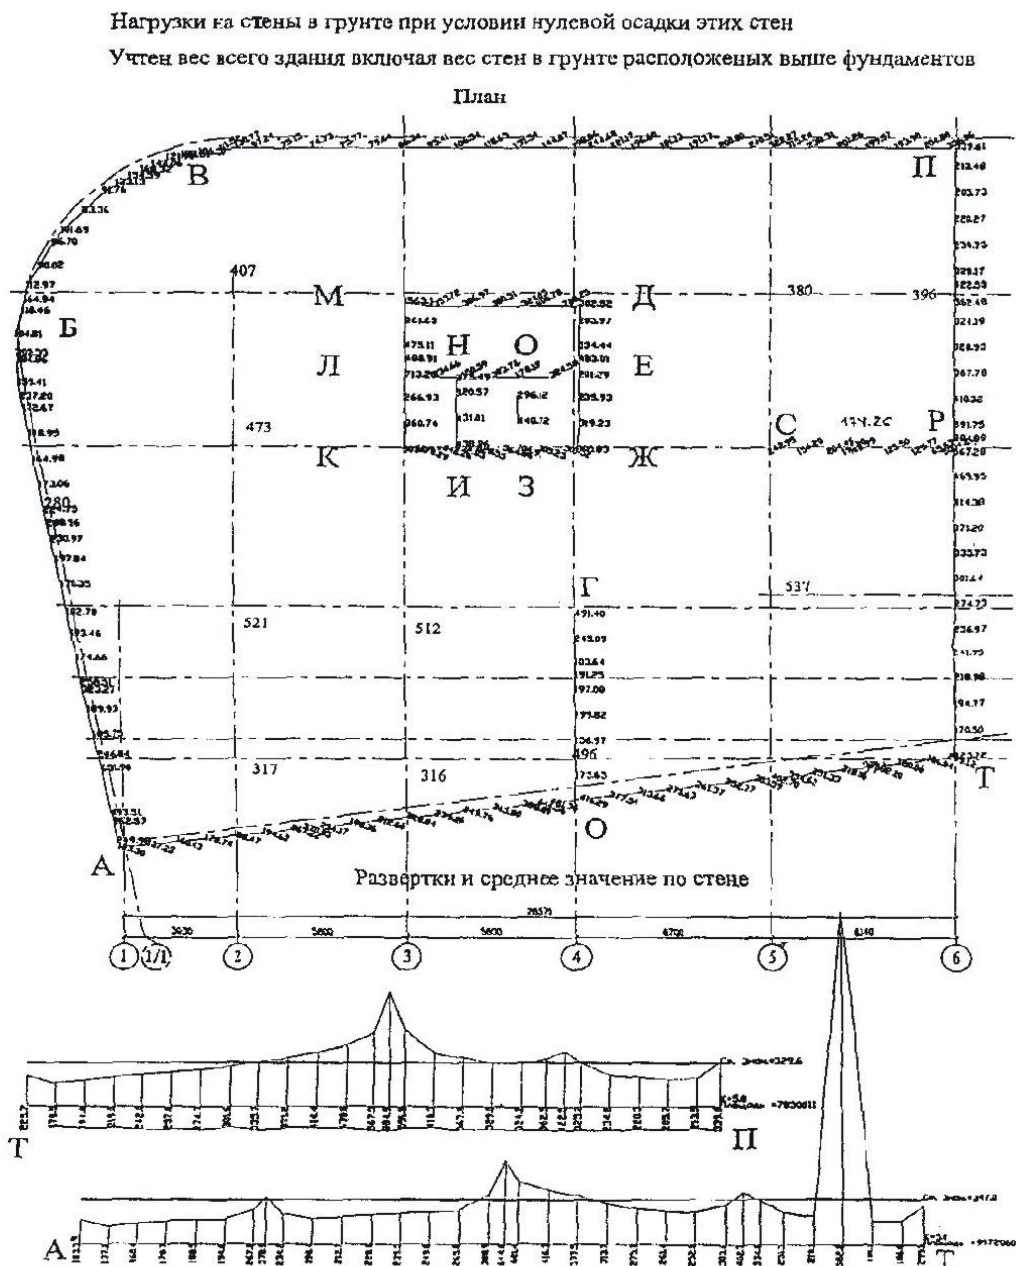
Нагрузки в уровне верха фундаментной плиты здания по Ермолаевскому пер., 15/44.
